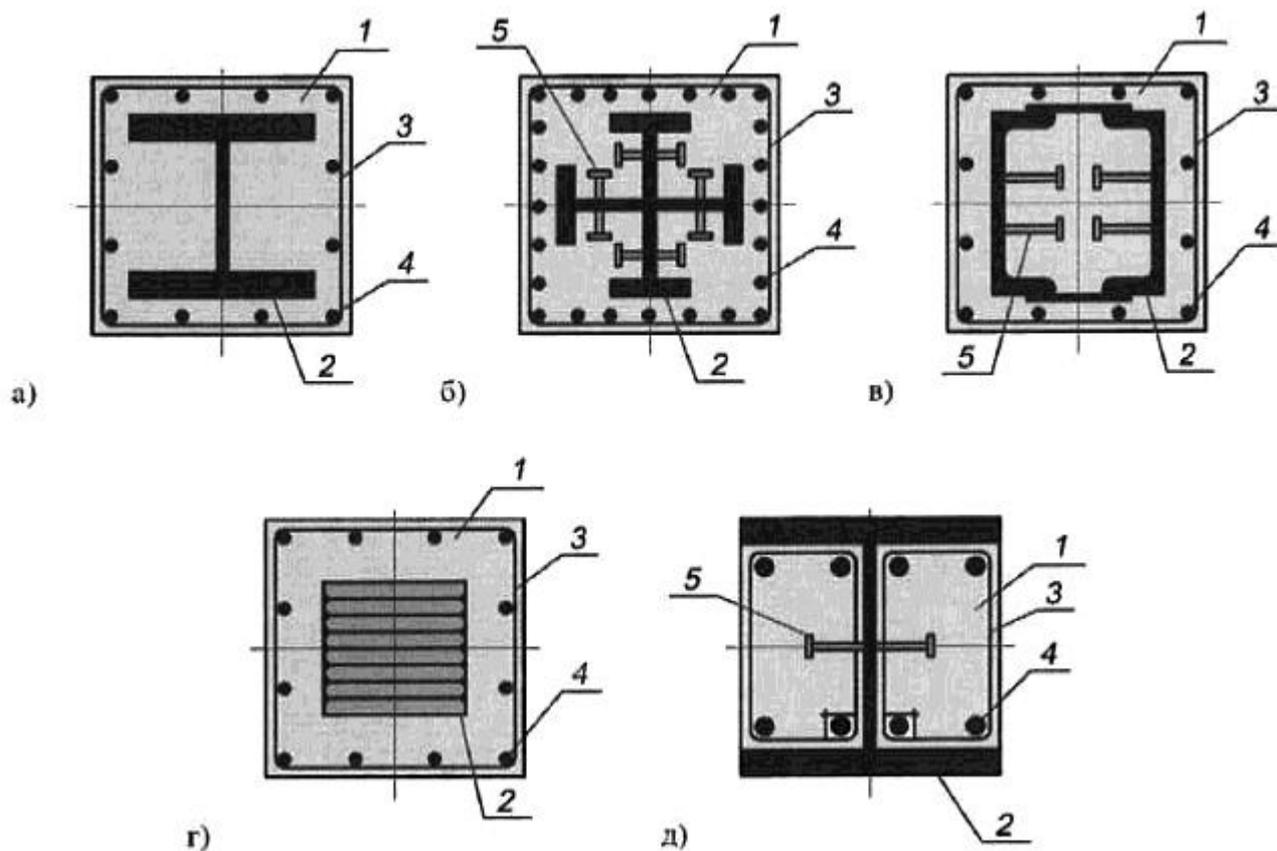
Типовые поперечные сечения железобетонных конструкций с жесткой арматурой
